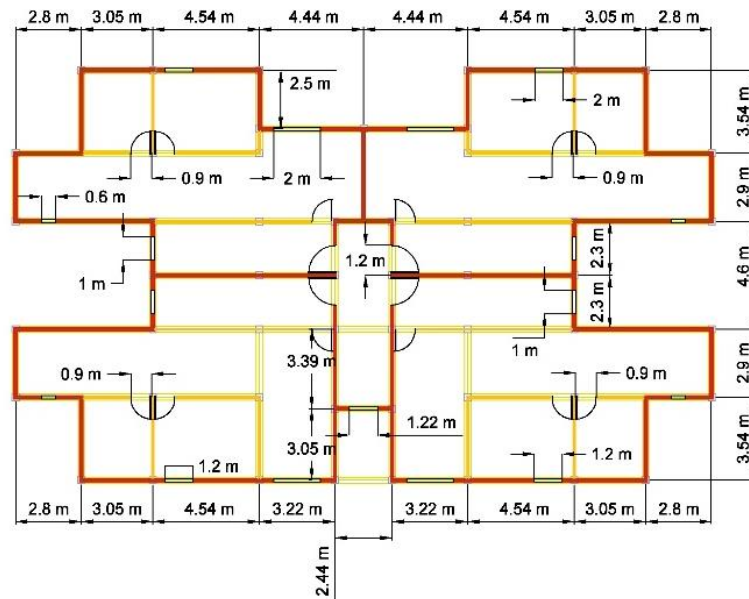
Edificio San Fernando -bloque 11- (Lorca). Distribución de cerramientos para una planta tipo
